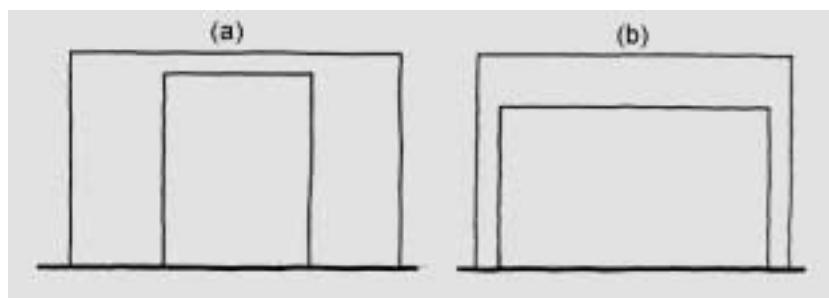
Rigidez do pilar em relação à viga de um pórtico
